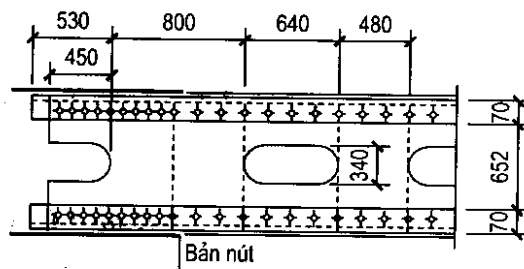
Bản giằng ở đầu của liên kết thanh giằng
